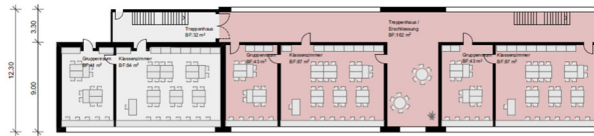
Disposition 01 | Grundriss 2. Obergeschoss
